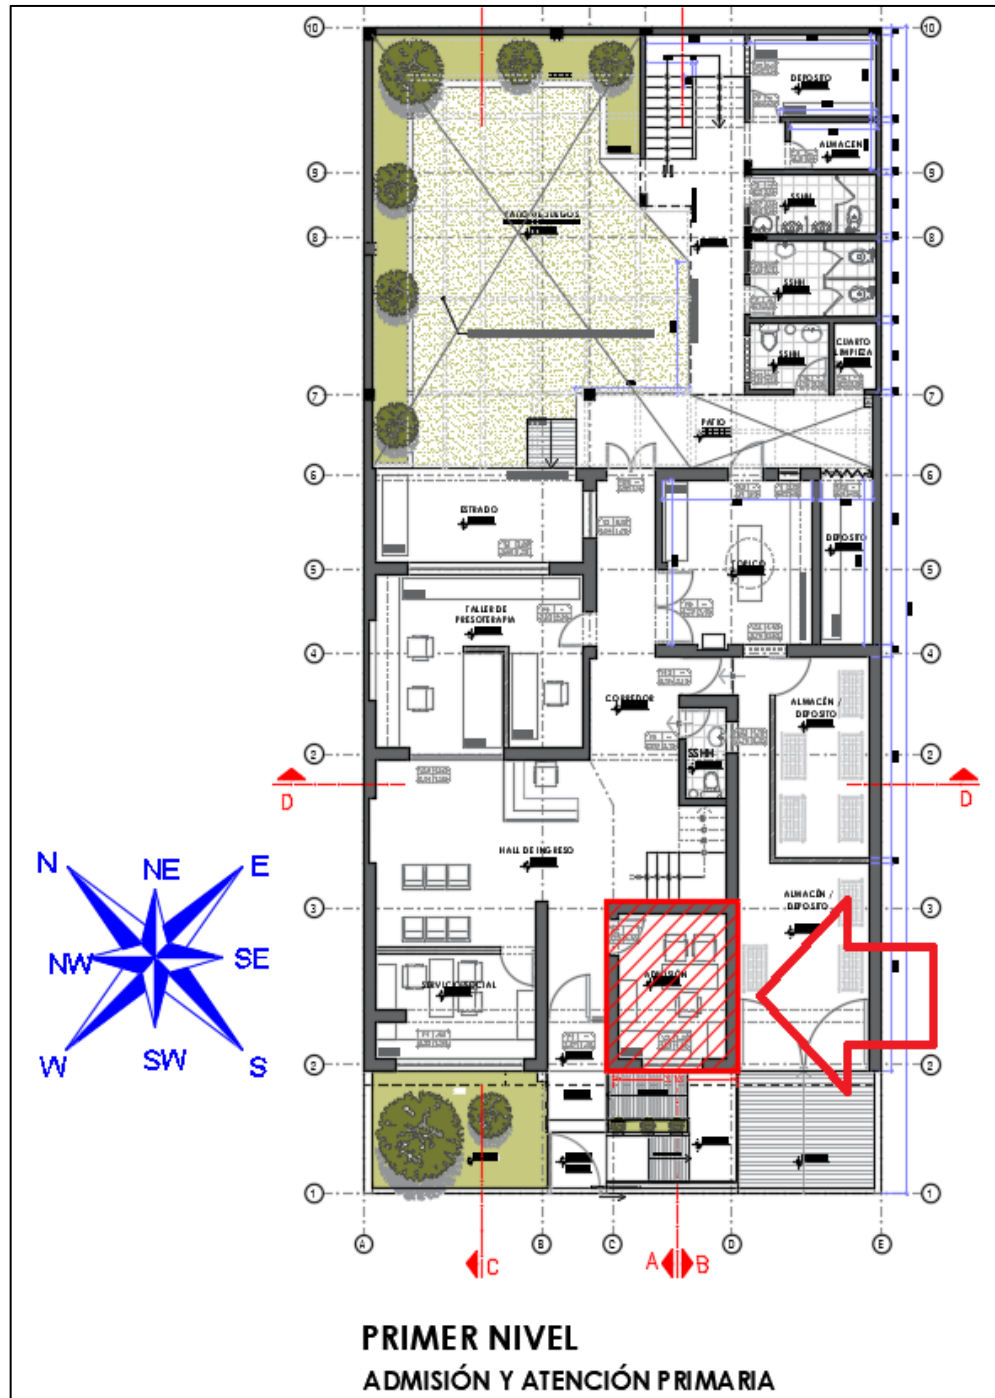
Plano vista de planta del piso 1 con la localización del área de ADMISIÓN, tomado de los planos de arquitectura brindados por el propietario de ANIQUEM.
